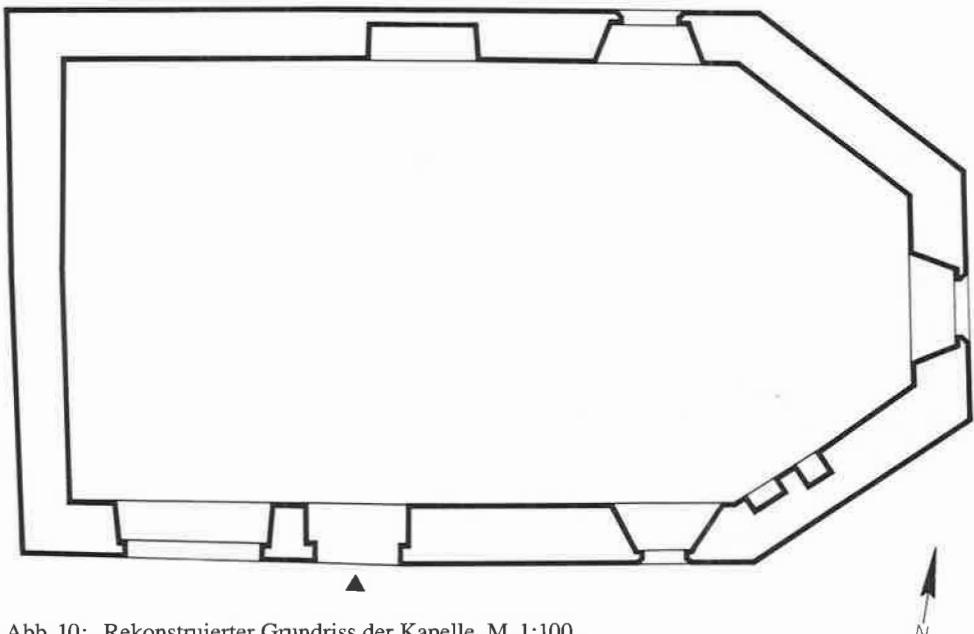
Rekonstruierter Grundriss der Kapelle. M. 1:100.
